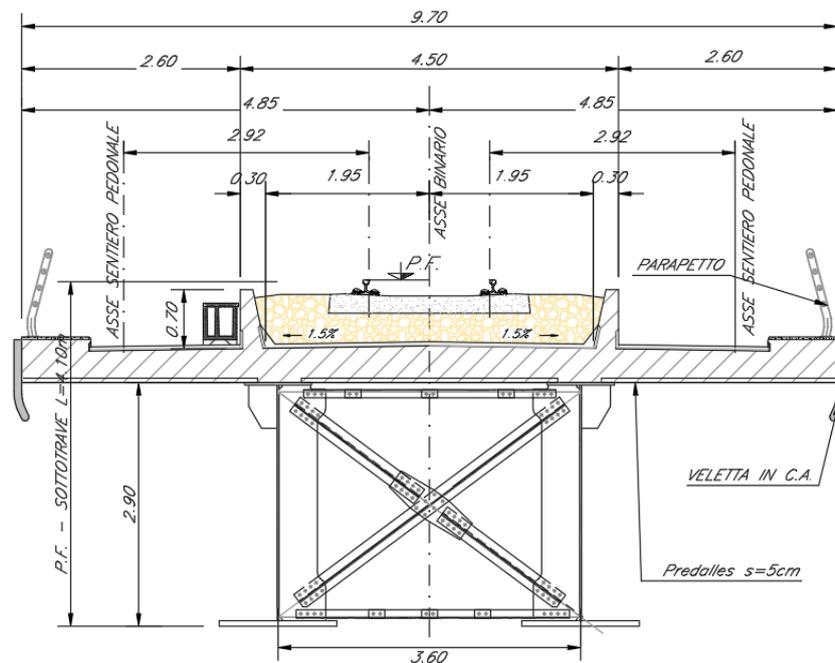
sezione trasversale impalcato tipo in acciaio 40m singolo binario
